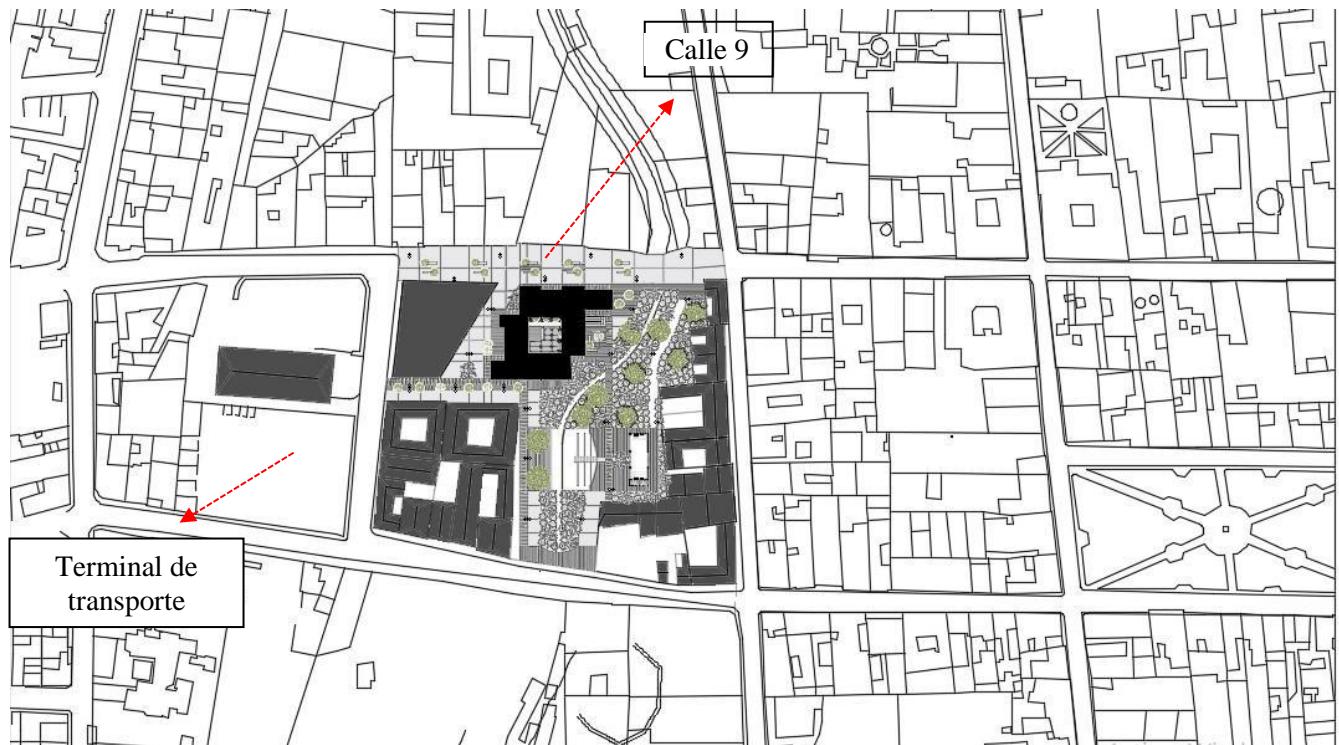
Planta de localización, Instituto de aprendizaje técnico de Leyva
